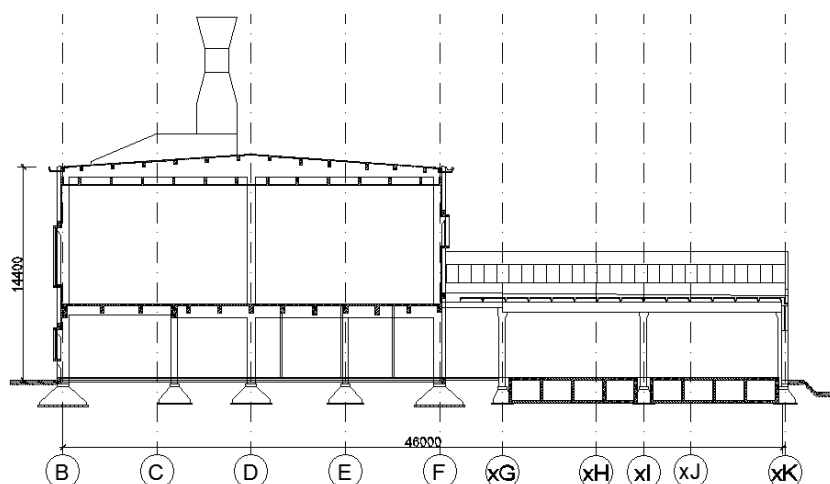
Przykładowy przekrój poprzeczny pierwszy
